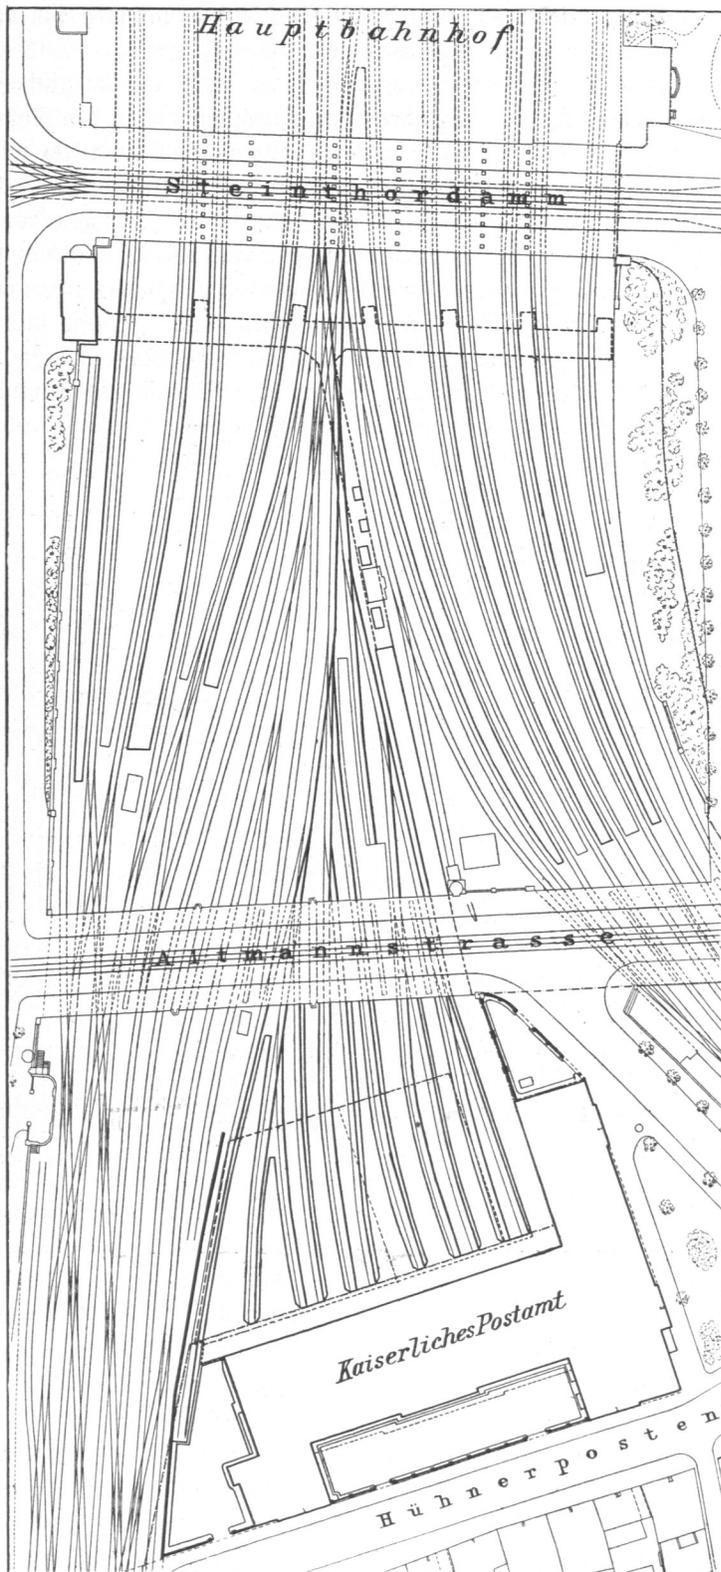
Postgebäude am Hauptbahnhof, Lageplan.
